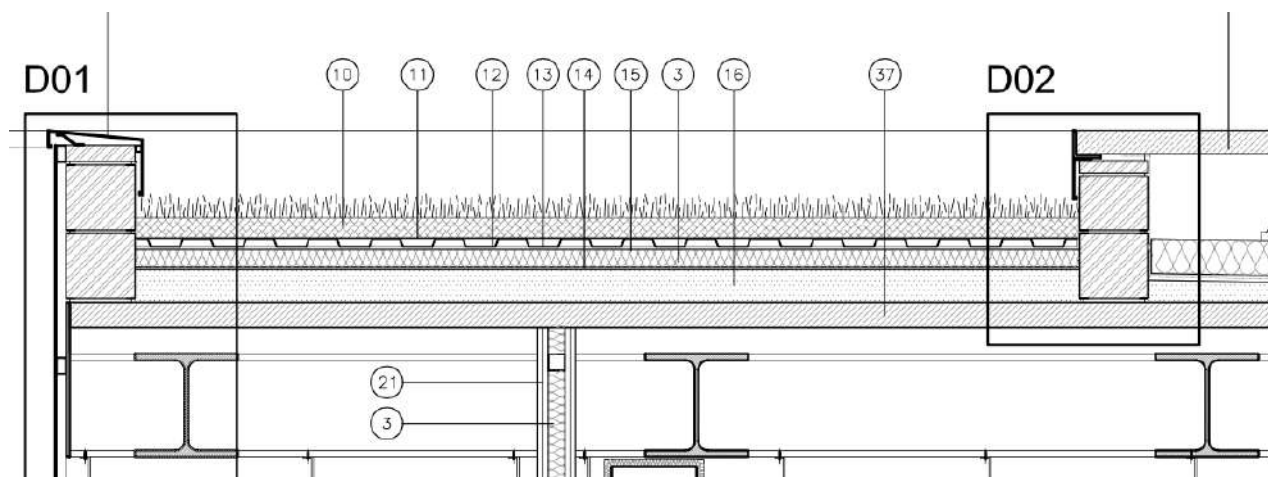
Detalle de cargas permanentes de cubierta verde sobre forjado metálico de chapa colaborante mixta
